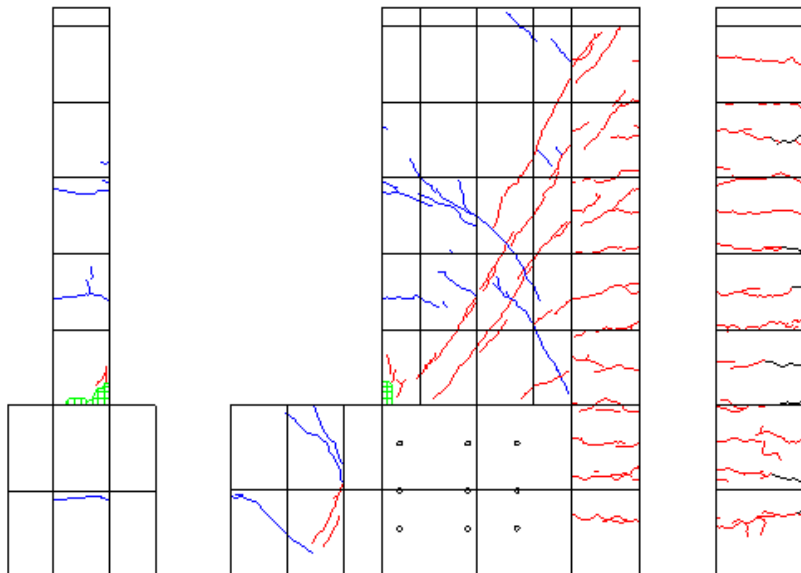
R=1/100②ひび割れ図
